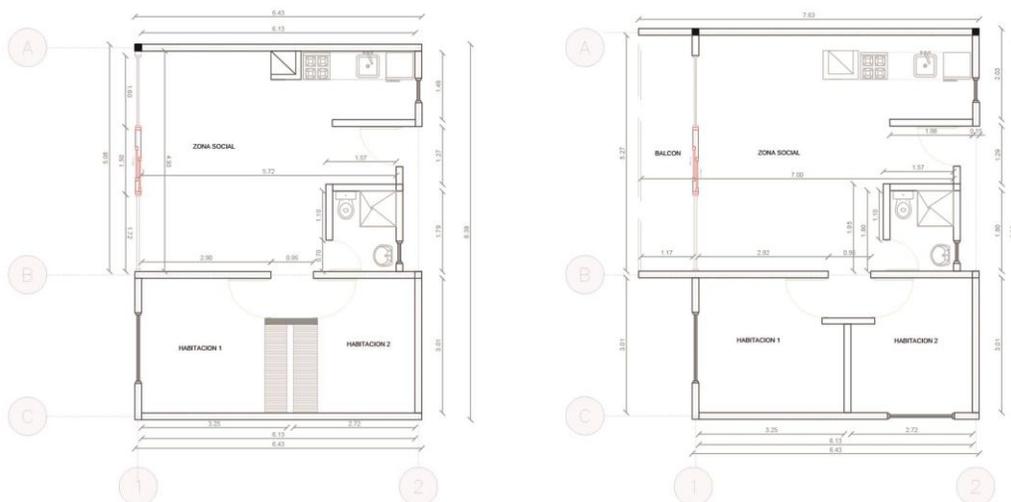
Propuesta Planta Equipamientos los Olivos.
